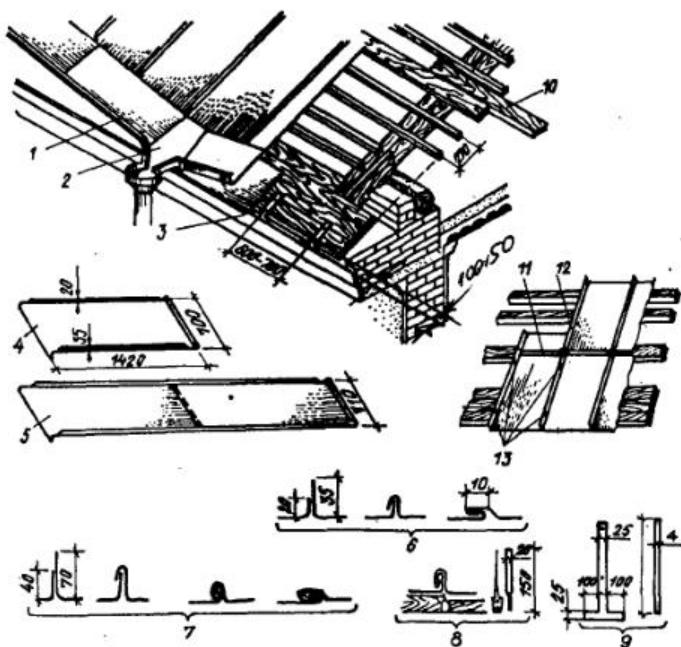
Конструкция, элементы металлической кровли: 1 — настенный желоб; 2 — лоток; 3 — капельник; 4 — картина; 5 — двойная картина; 6 — одинарный фальц; 7 — двойной фальц; 8 — кляммеры; 9 — костили; 10 — обрешетка; 11 — лежачий фальц; 12 — стоячий фальц; 13 — кляммеры.
